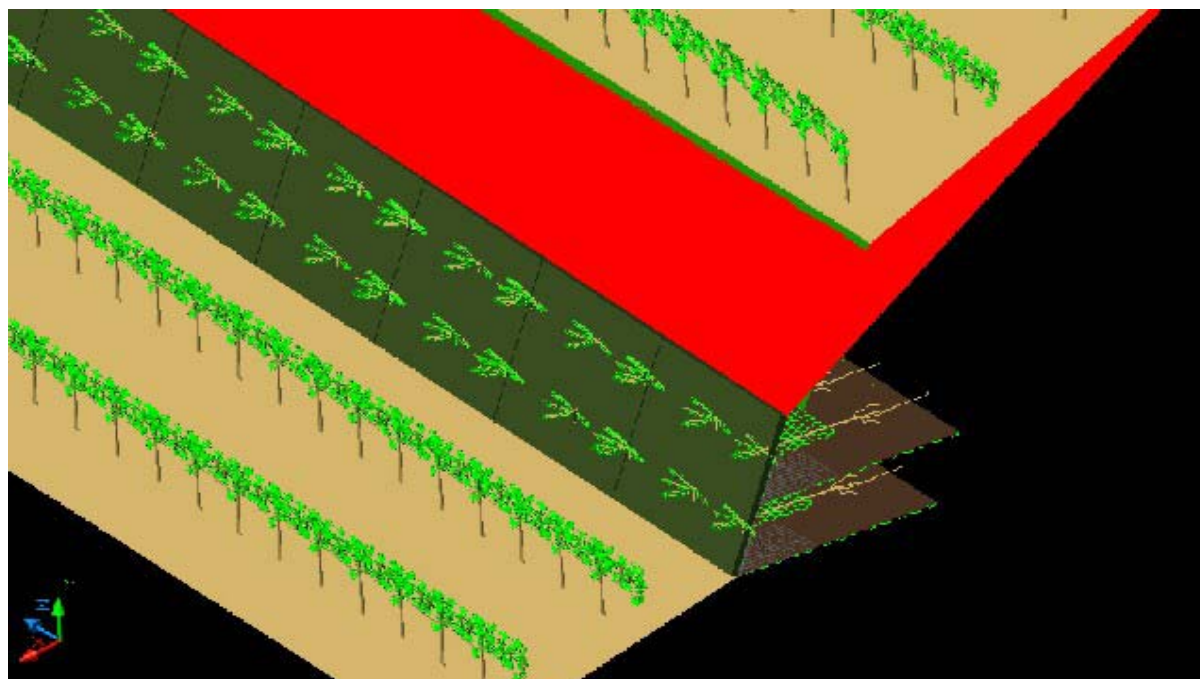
Particolare di vista tridimensionale della porzione dell'impianto ristrutturato con le modifiche apportate con la realizzazione della terra rinforzata. Il ripiano in rosso rappresenta la nuova superficie coltivabile, mentre sono ben visibili le talee inserite nella struttura modulare.
